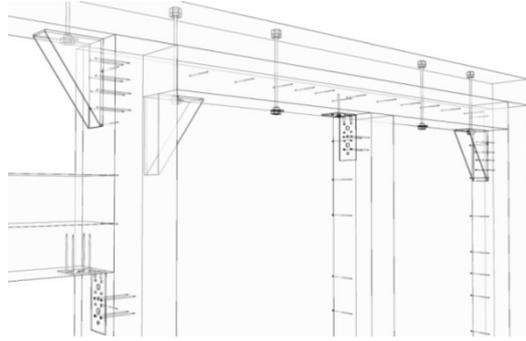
Schémas de principe de l'assemblage d'un panneau VT sur la traverse haute de l'ossature
